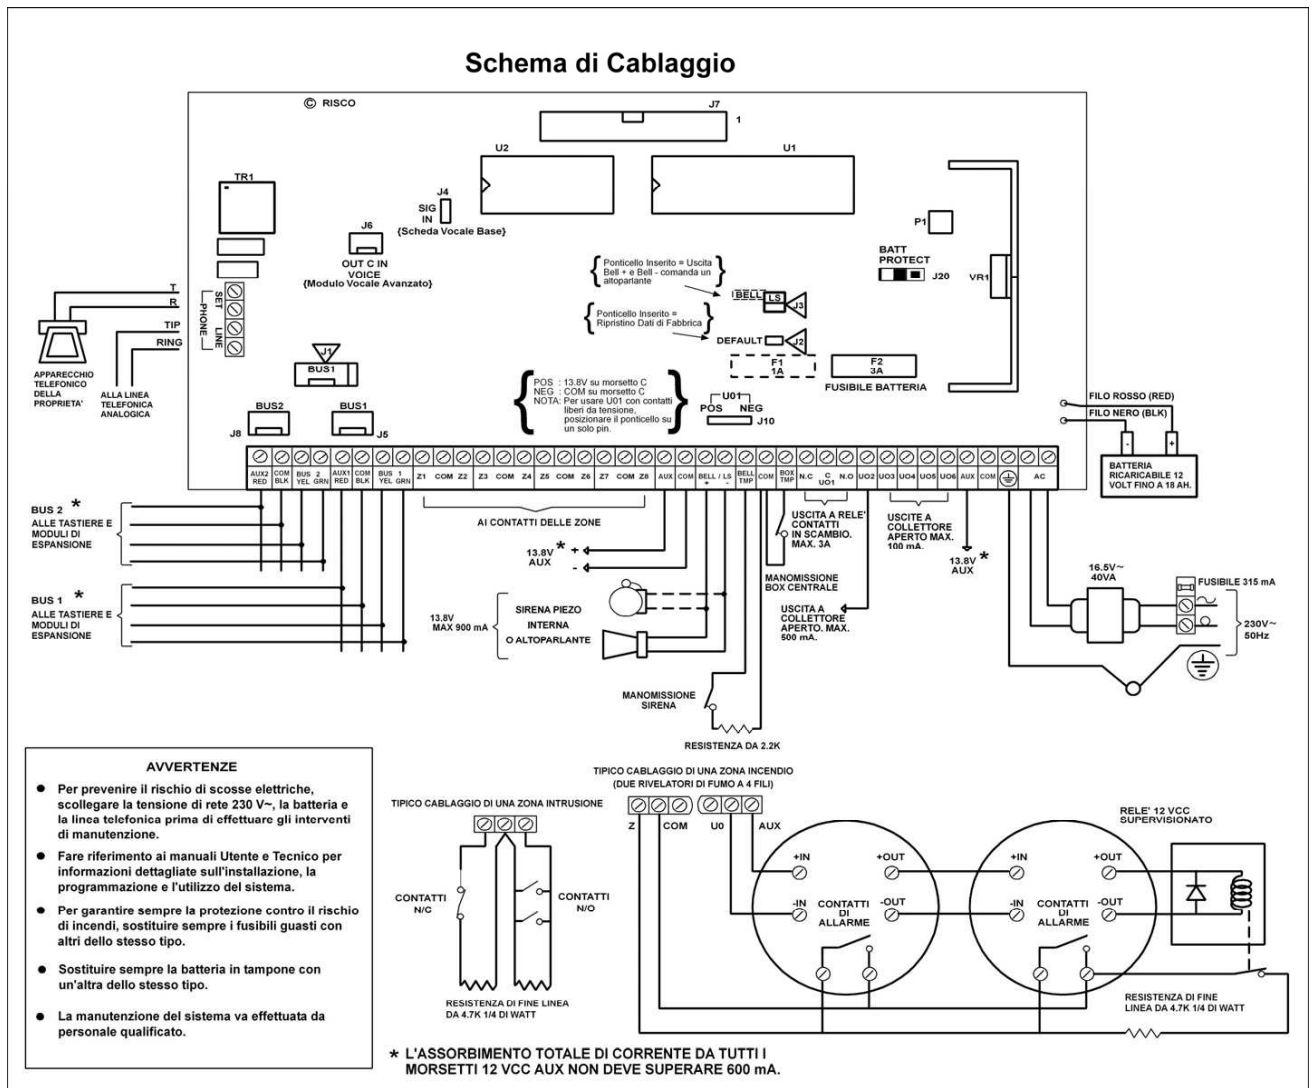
Schema di Cablaggio della Scheda Principale.
